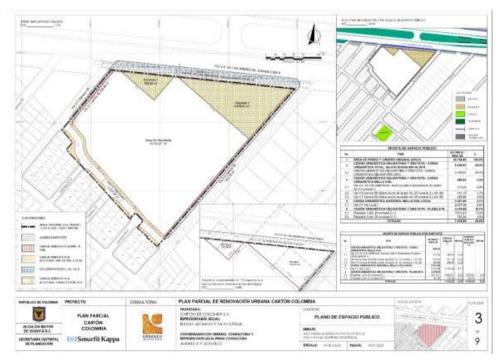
Plano de Espacio Público del planteamiento urbanístico del PPRU-CC Elaboración propia
